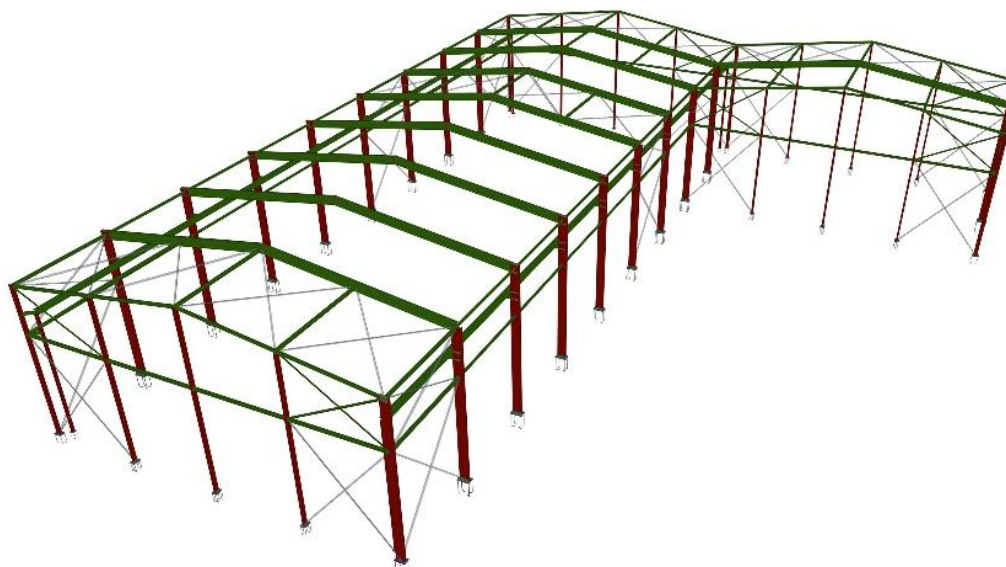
Estructura 3D (fuente: Cype 3D)
